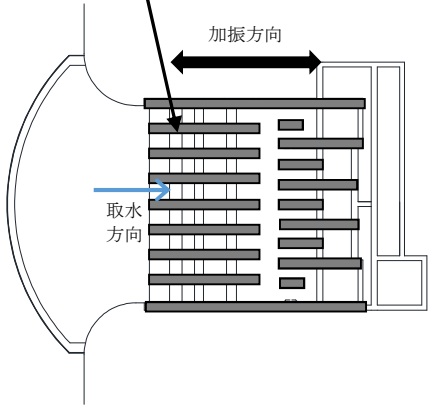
(2) 取水構造物の平面配置図 (拡大図)
